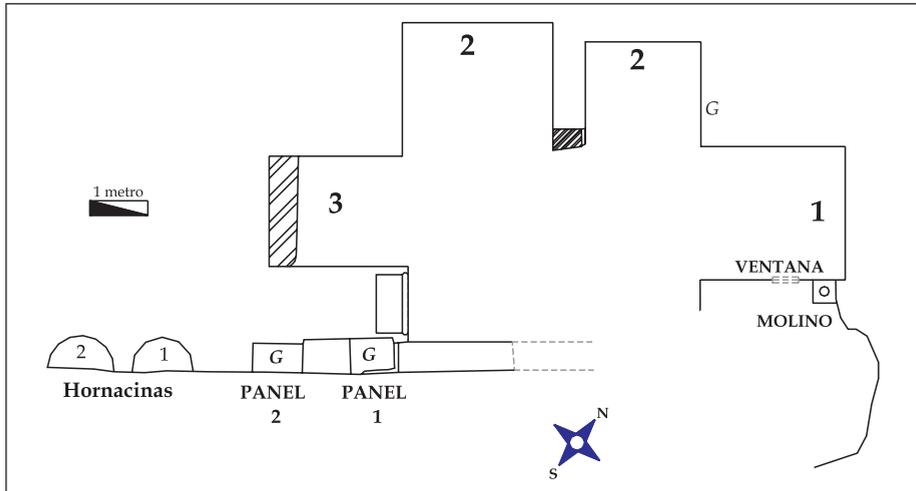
Planta del eremitorio QM A-1 o Cueva de ʿAnṭar
